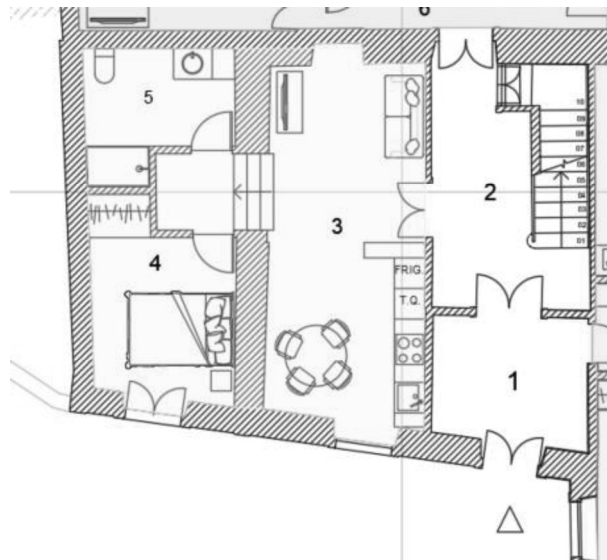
Planta do apartamento número 2 do piso 0 | Beatriz Figueiredo
